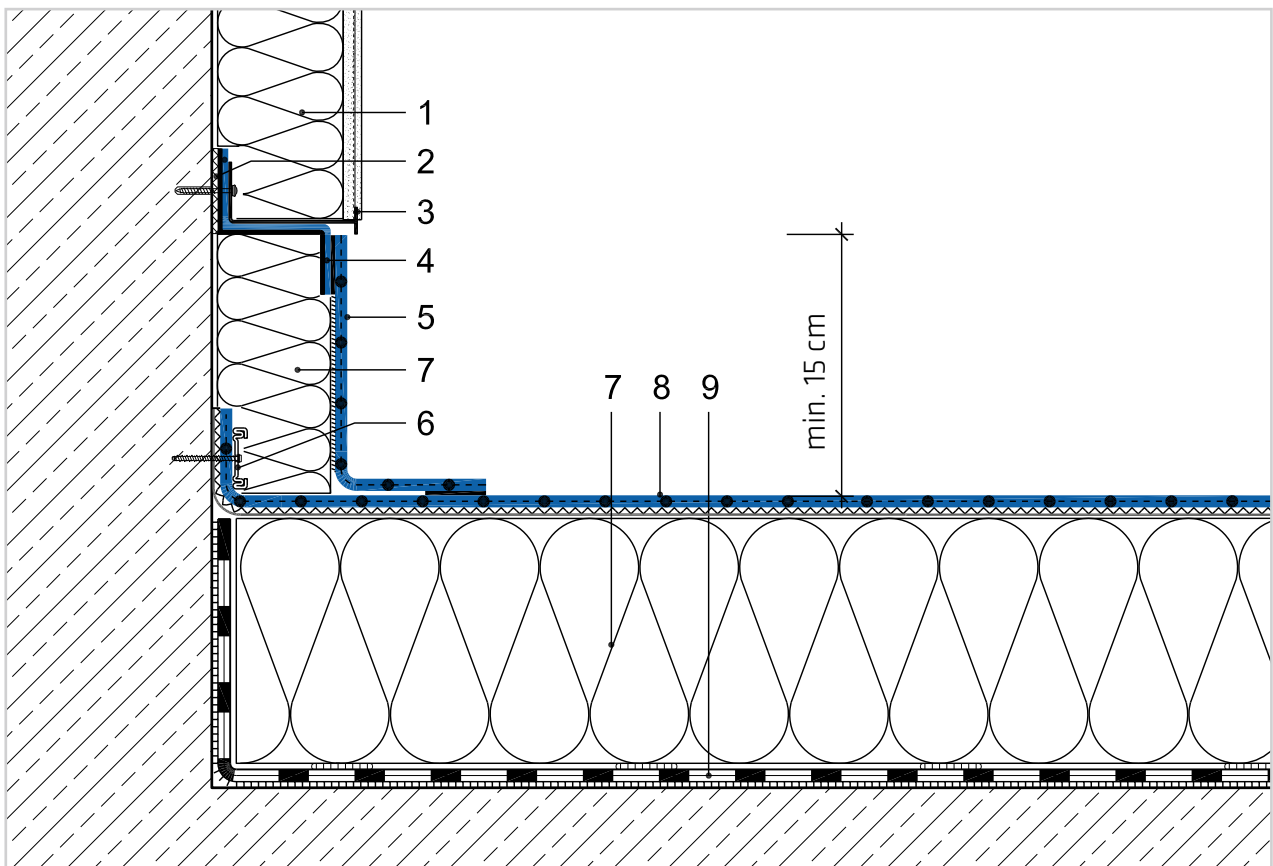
Wandanschluss gedämmt (System Auflast)
